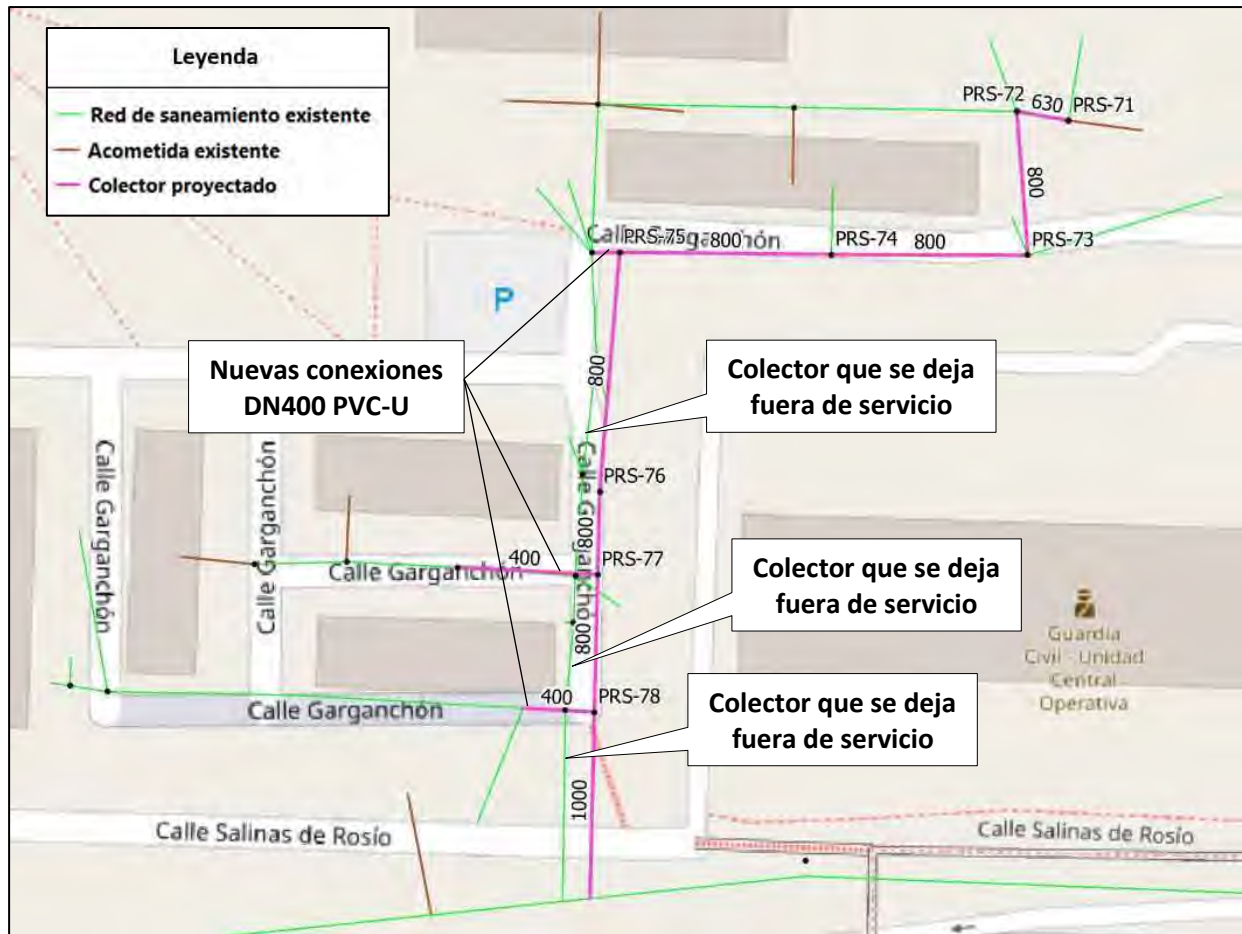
Colector proyectado en la calle Garganchón. Detalle en planta de la actuación.
